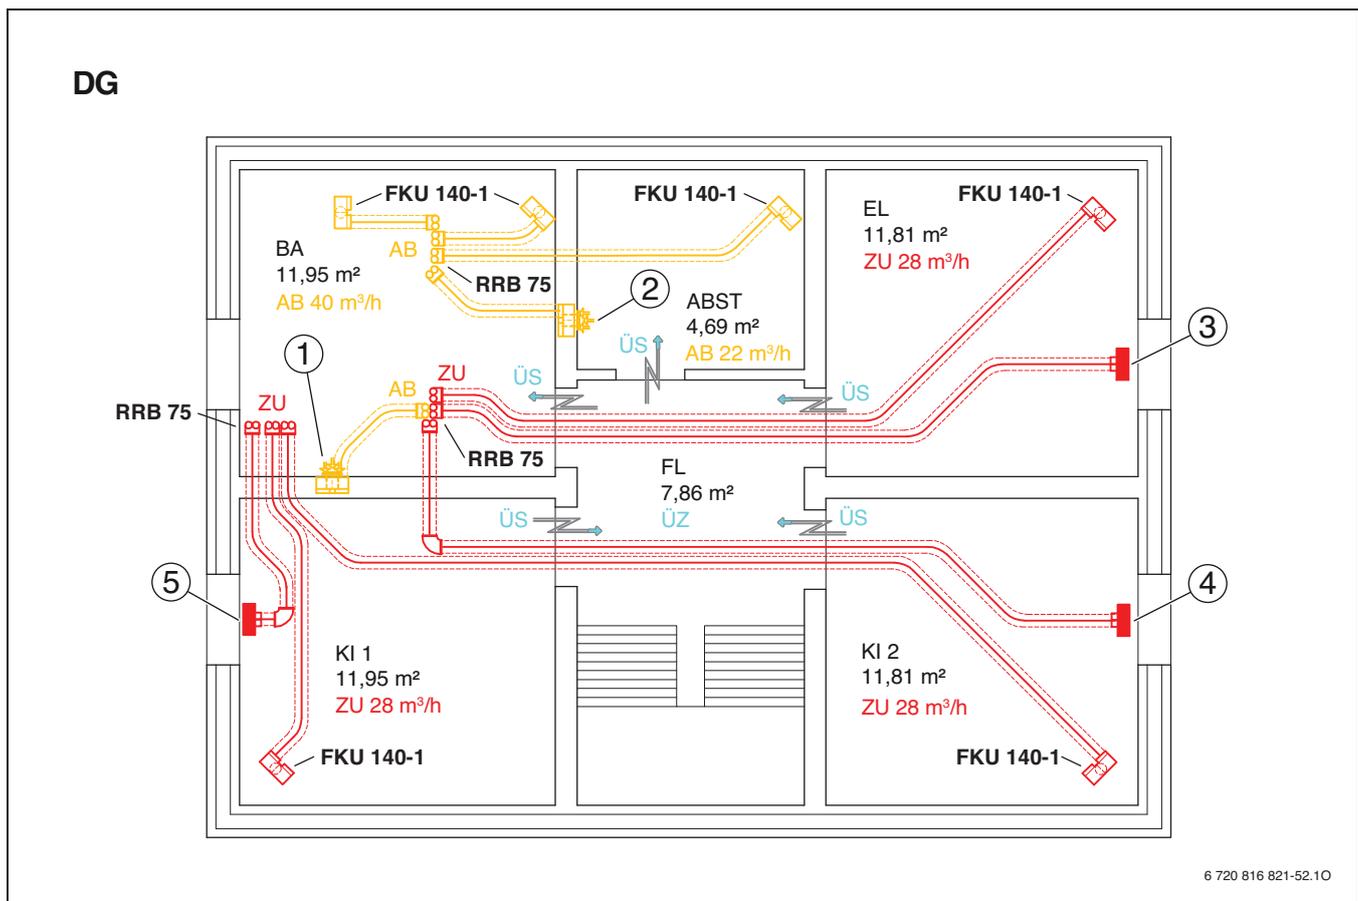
Pianta soffitta abitabile con installazione ventilazione
